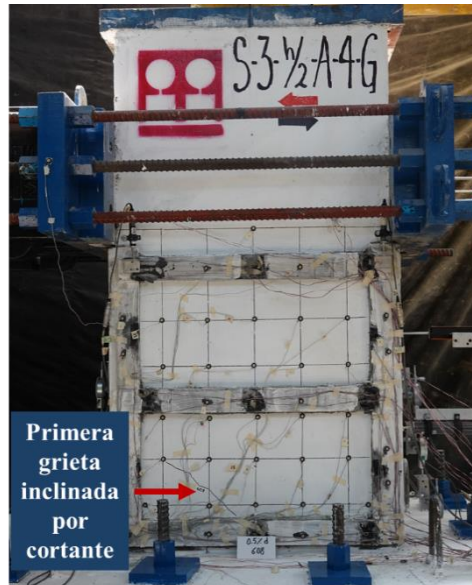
Aparición de la primera grieta por cortante en la cara Norte (ciclo 1, distorsión $+0.5\%$).
